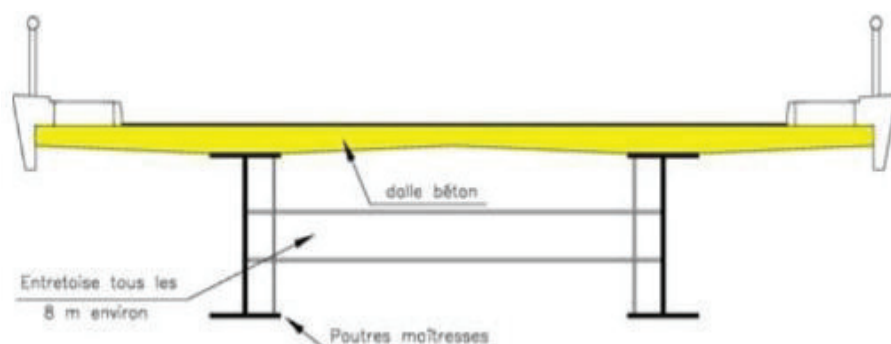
Morphologie général d'un pont bipoutre à entretoise.
